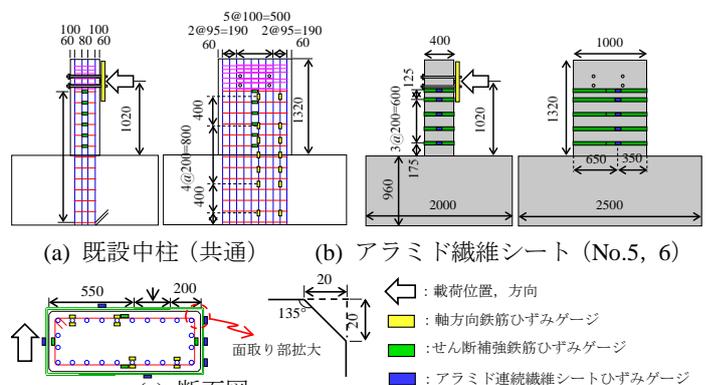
供試体諸元およびひずみ計測位置 (単位: mm)
